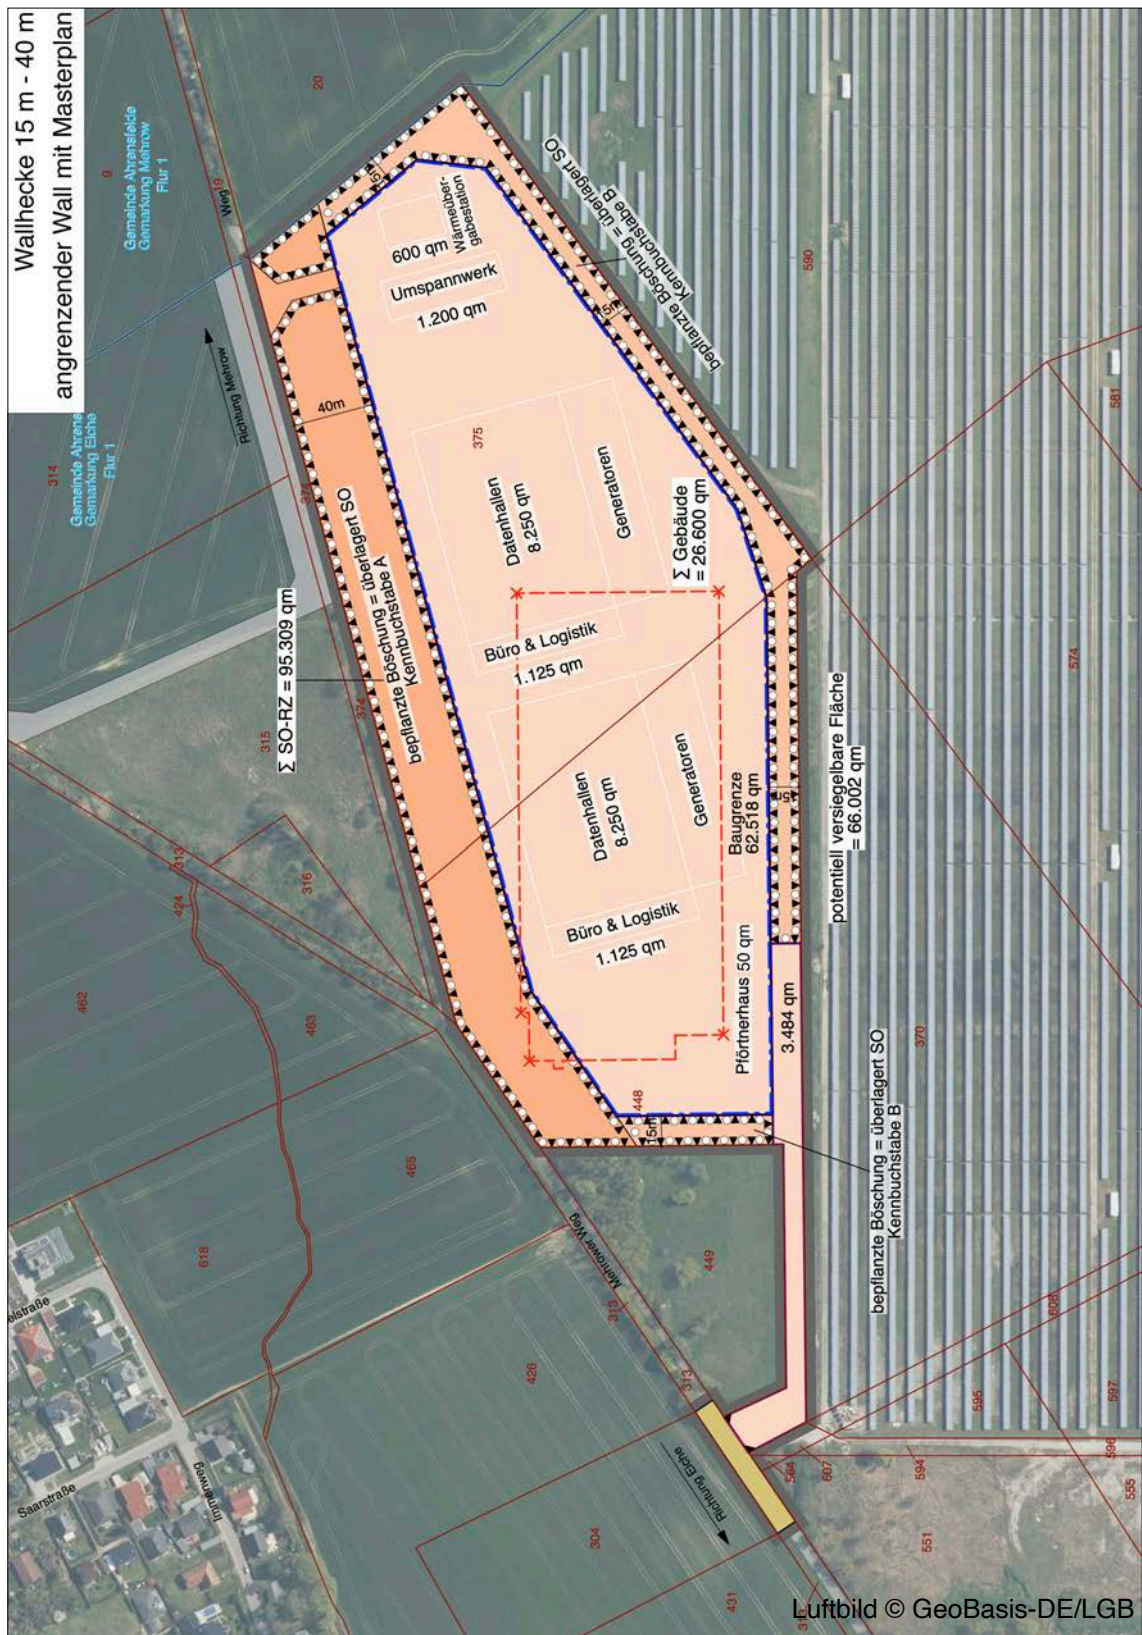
Wallhecke 15 - 40 m mit Masterplanung - TTSP HWP Planungsgesellschaft mbH (Stand: 19.03.2025)
